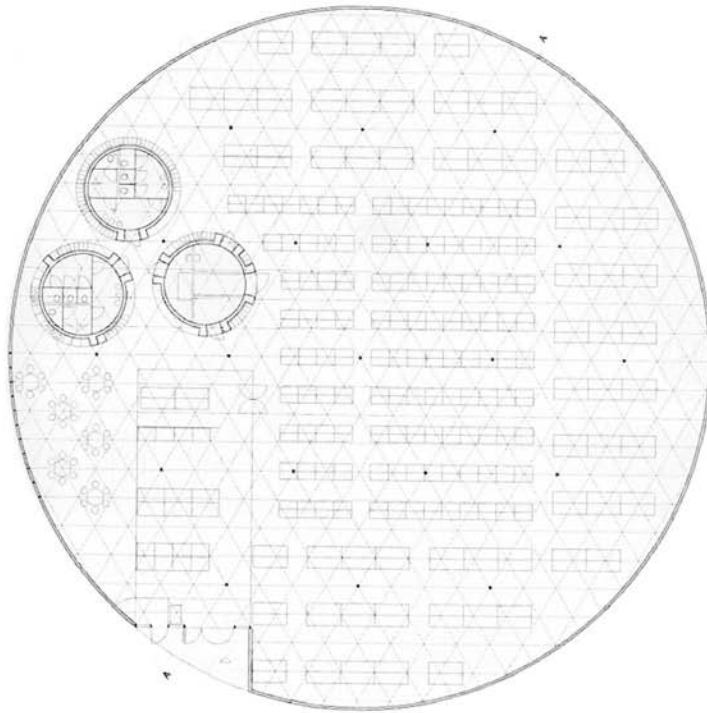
Grundriss [Lees 09] S.35
